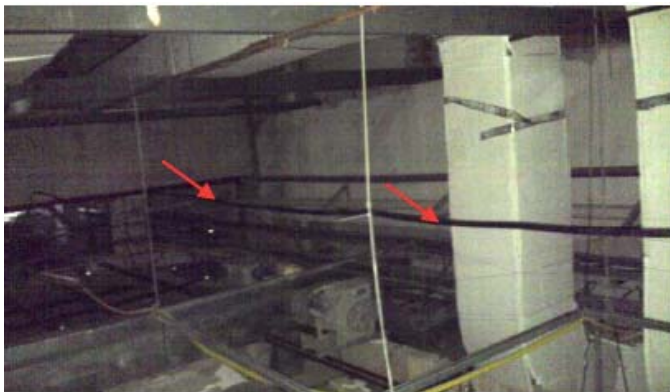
Vista do cabo fixado no estirante de fixação do forro.
